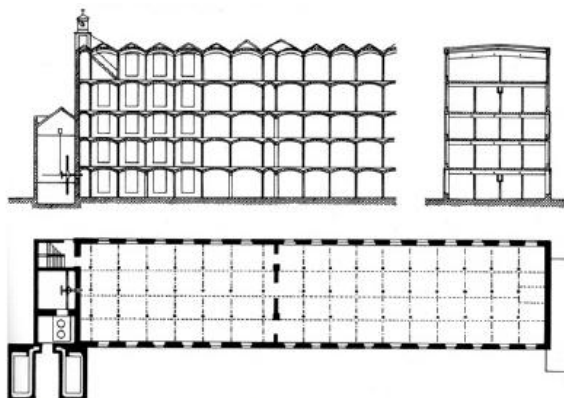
2: Planta e Corte da Fábrica de Fiação em Ditherington, Shrewsbury, Inglaterra, 1796/1797. Fonte: AW Skempton & HR. Johnson. 'The First Iron Frames.' *Architectural Review*, v. 131, 1962, p. 181. Apud GUEDES (2010)
